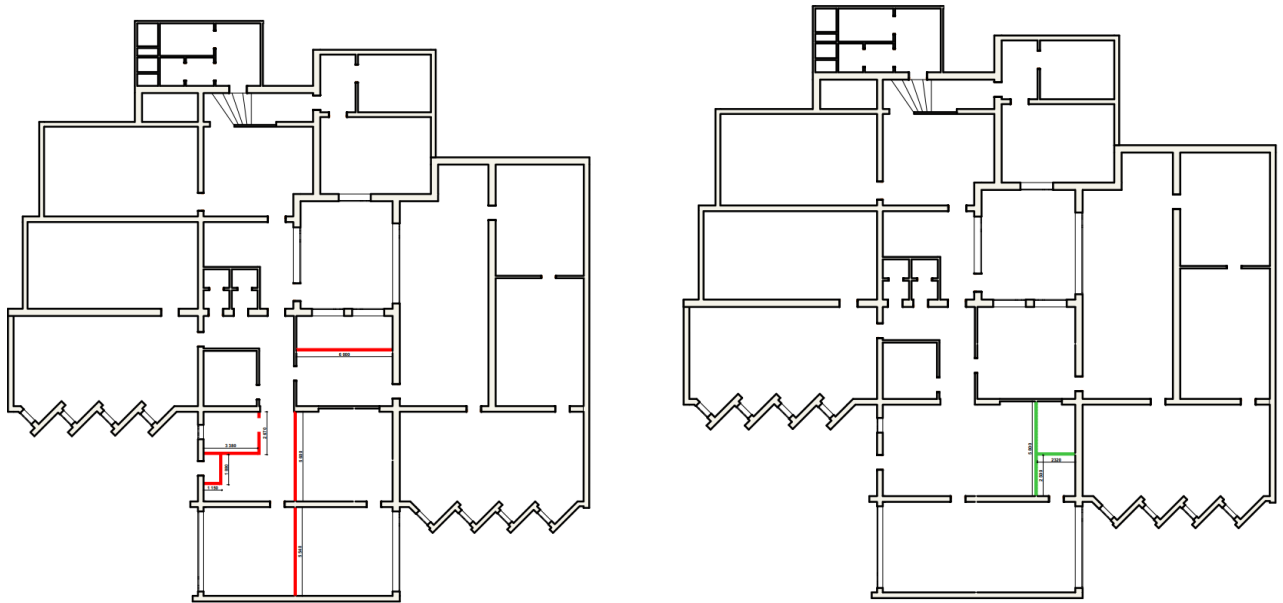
,2 Схеми демонтажу та монтажу приміщень
